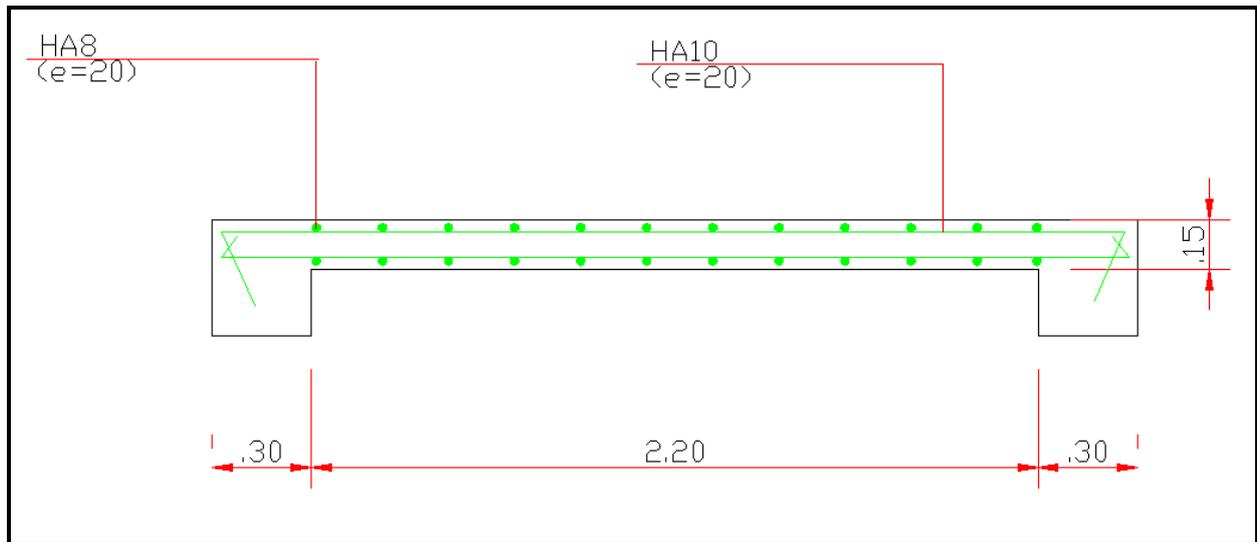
ferrailage balcon 01 (coupe B-B).
